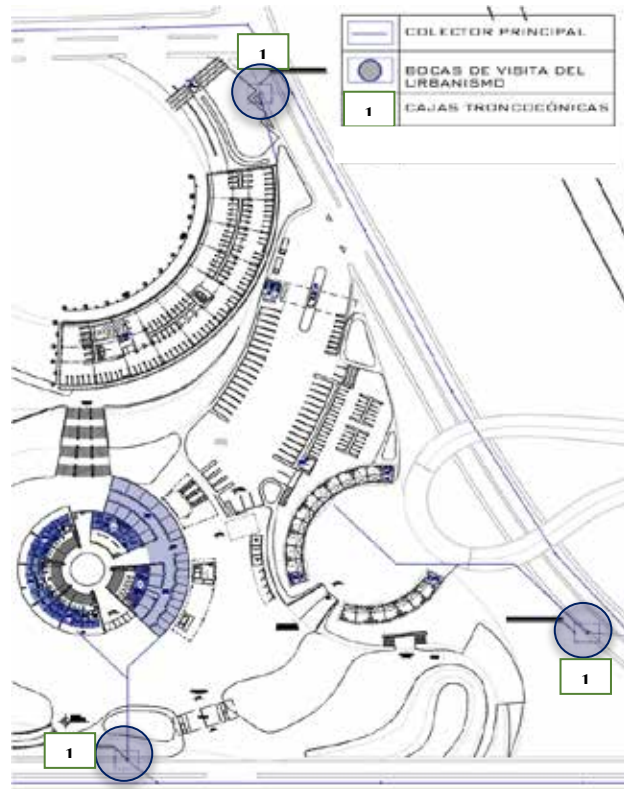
Ubicación de red principal de aguas servidas en planta baja conjunto. La Autora (2020)
